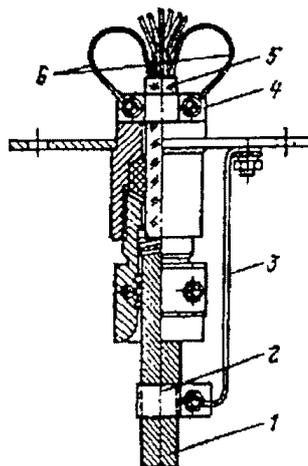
Схема заземления контрольного кабеля с пластмассовой оболочкой:
